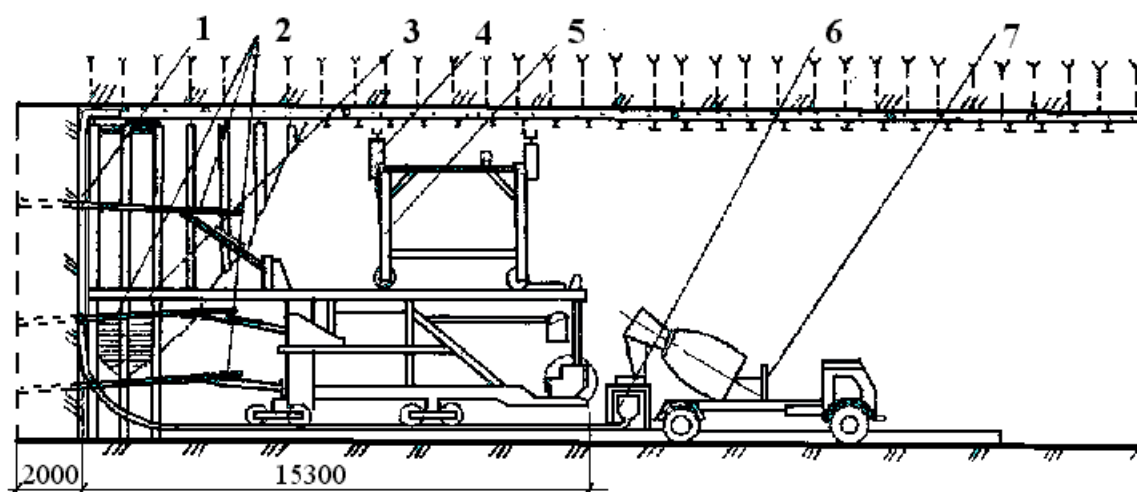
Укладка бетонной смеси в наружный слой обделки тоннеля и бурение шпуров в забое.
